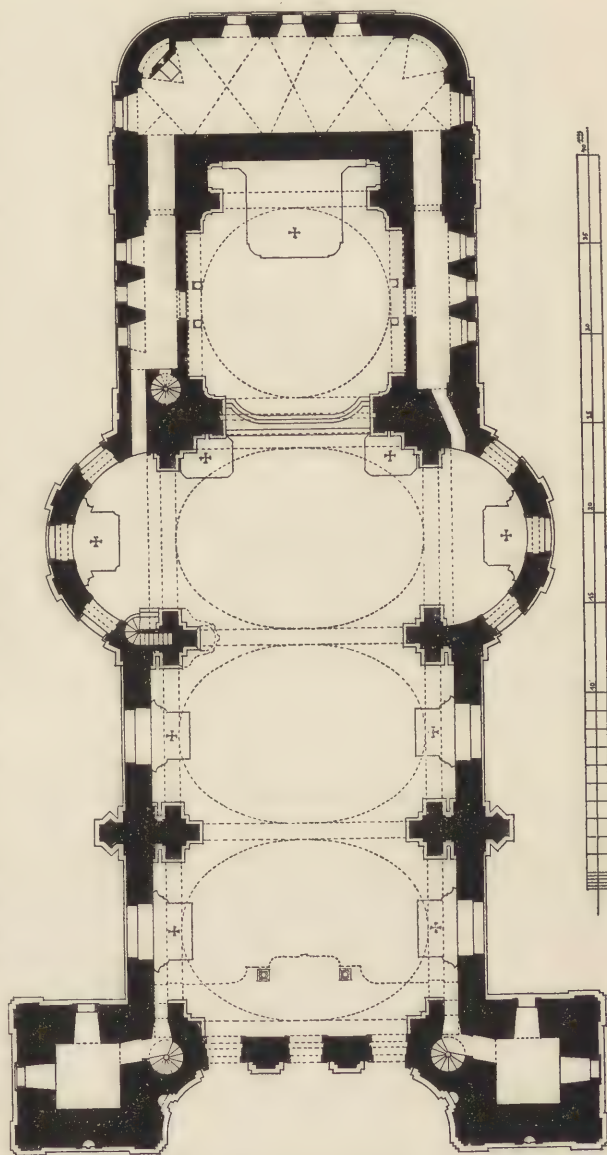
St. Jacobskirche zu Innsbruck, Grundriss.
